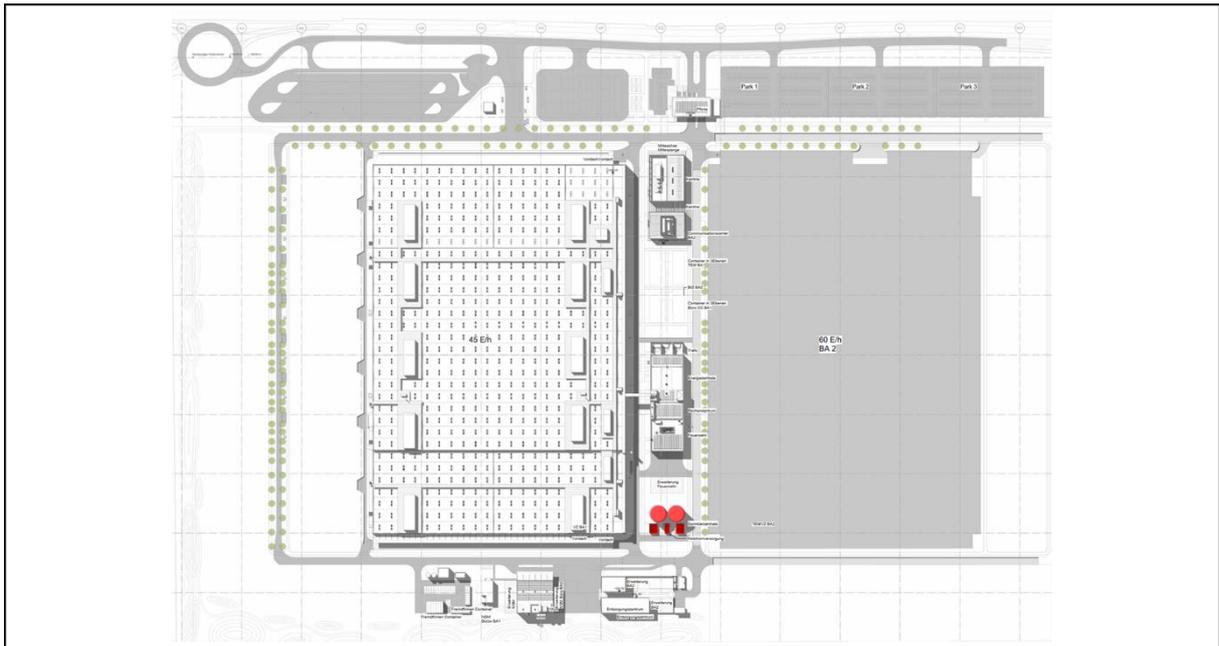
Sprinklerzentrale/ NSV - Lageplan Dachaufsicht.
